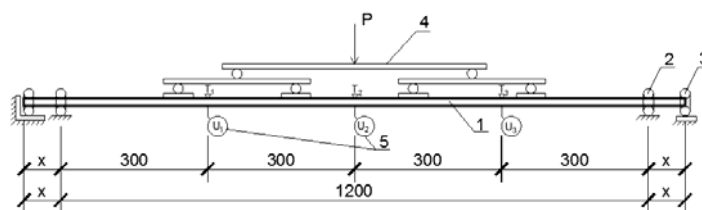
Схема испытания образца: 1 – образец; 2 – опора; 3 – цилиндрический каток; 4 – нагружающая платформа; 5 – прогибомер 6 – ПАО-Ц-0,01
